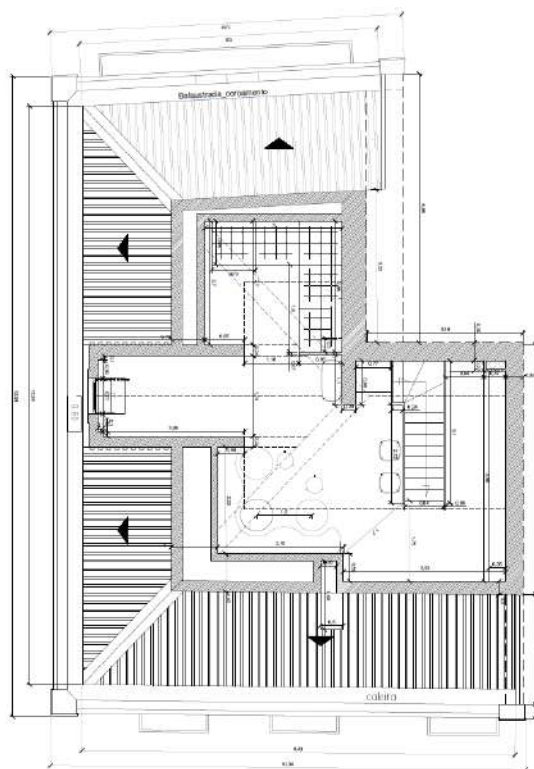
Planta de Apresentação Cotada - Piso das Águas-Furtadas
